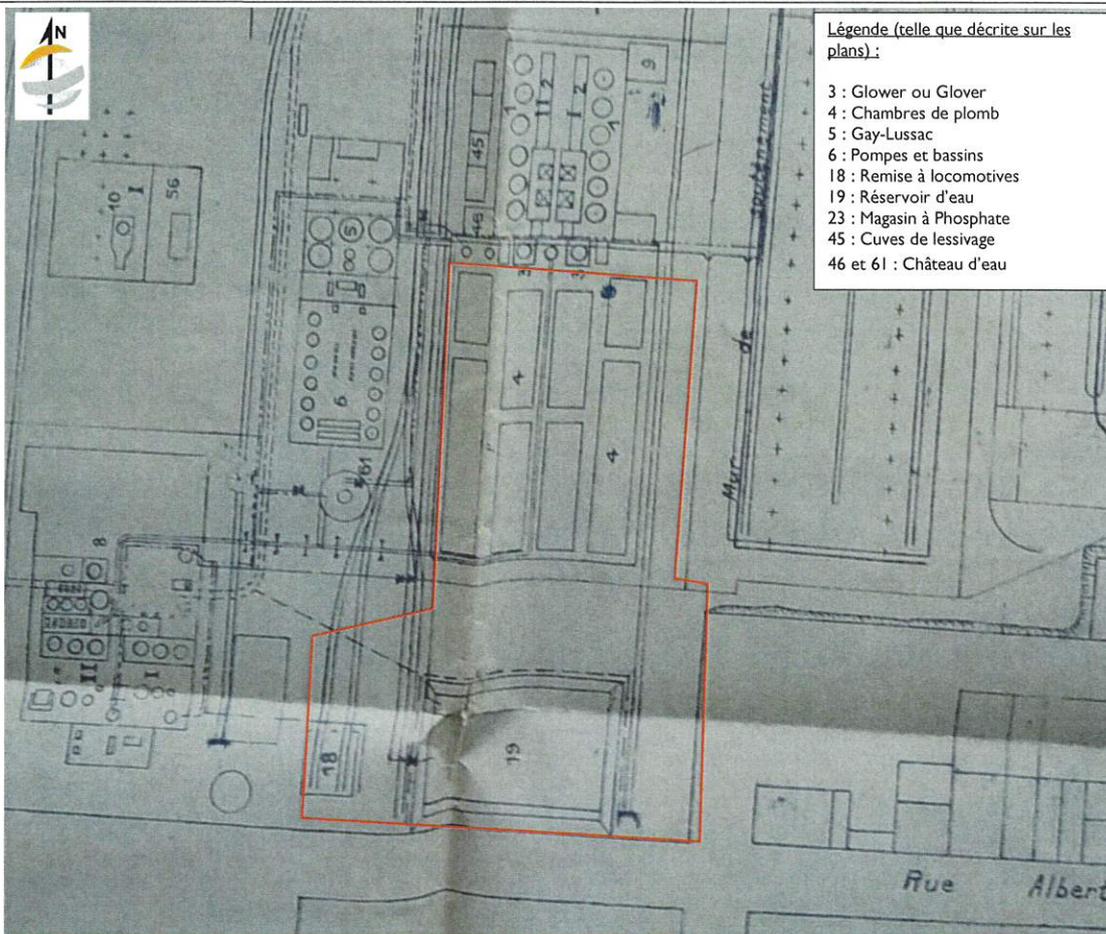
Extrait du plan d'ensemble de 1952 - Dossier 216 W 6
